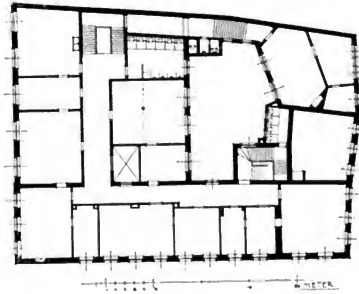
u. 407. Geschäftshaus Engelhardt & Biermann, Langenstraße. W. Sunkel. 1891. Grundrisse der beiden Hauptgeschoße.
